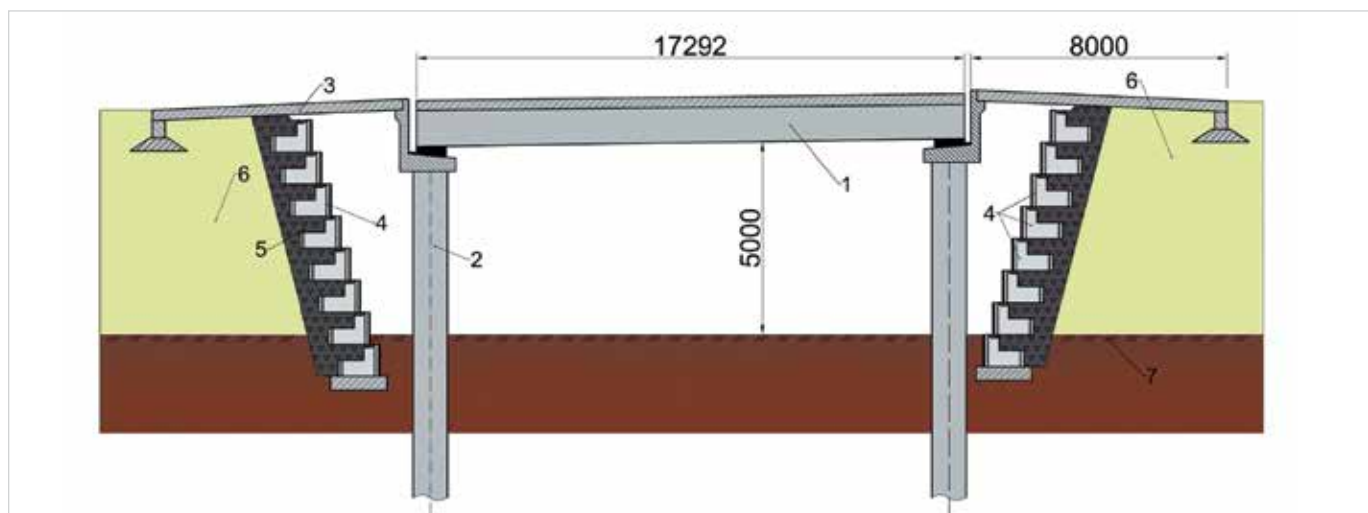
Автодорожный путепровод с устоями с разделенными функциями в виде наклонных подпорных стен из блоков КБП. 1 - ж/б пролетное строение, 2 - безростверковые опоры из буровых свай, 3 - переходные плиты, 4 - ж/б блоки КБП, 5 - заполнение щебнем, 6 - насыпь из песка, 7 - грунт основания
